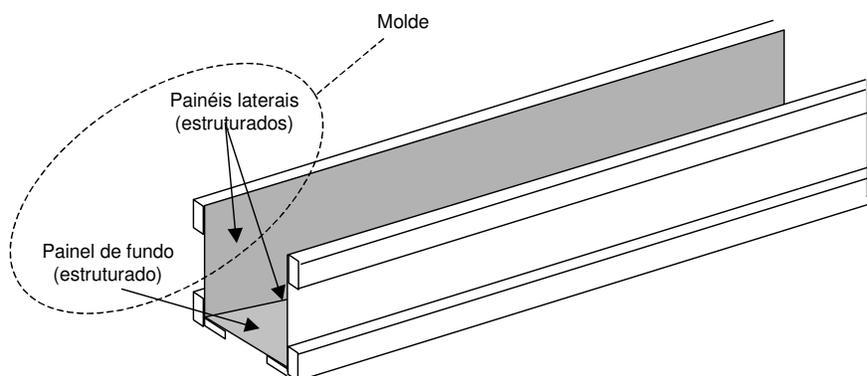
Perspectiva de uma fôrma tradicional para viga, com molde em chapa de compensado estruturado com sarrafos.
